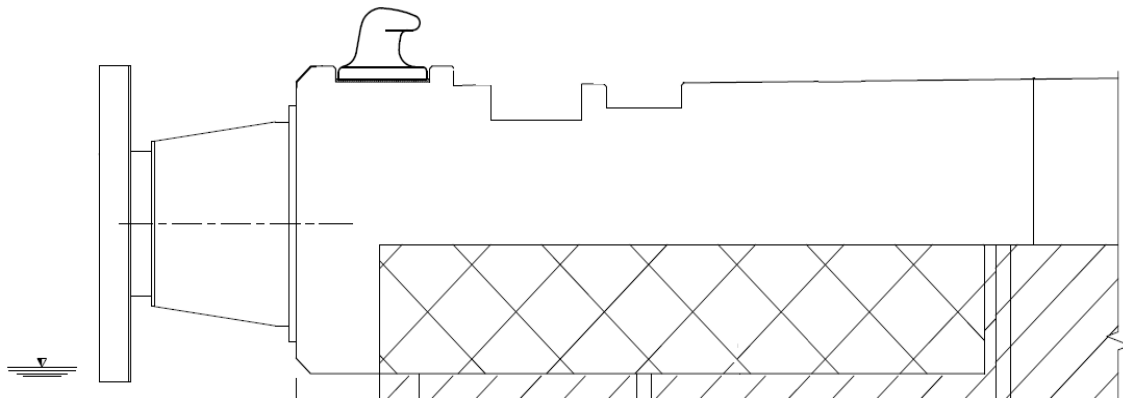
Elementos de bolardo y defensas sobre viga cantil
